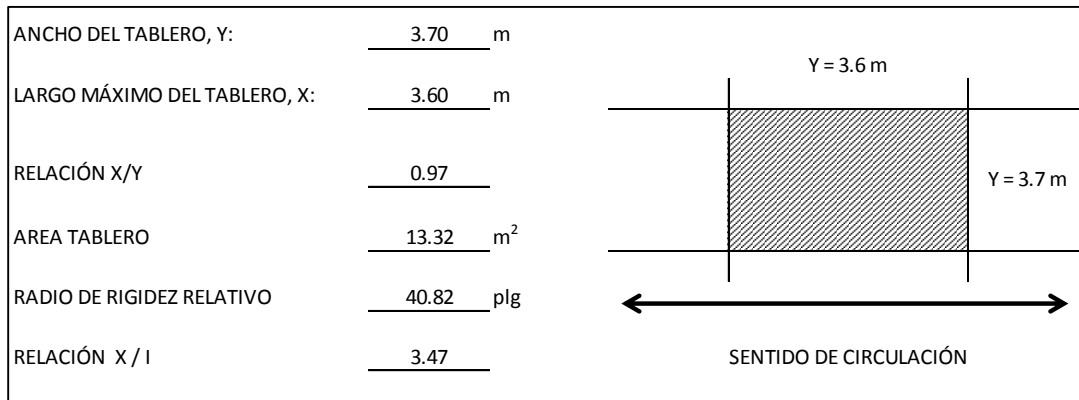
Dimensionamiento de la Losa de Concreto Hidráulico para Vialidad
